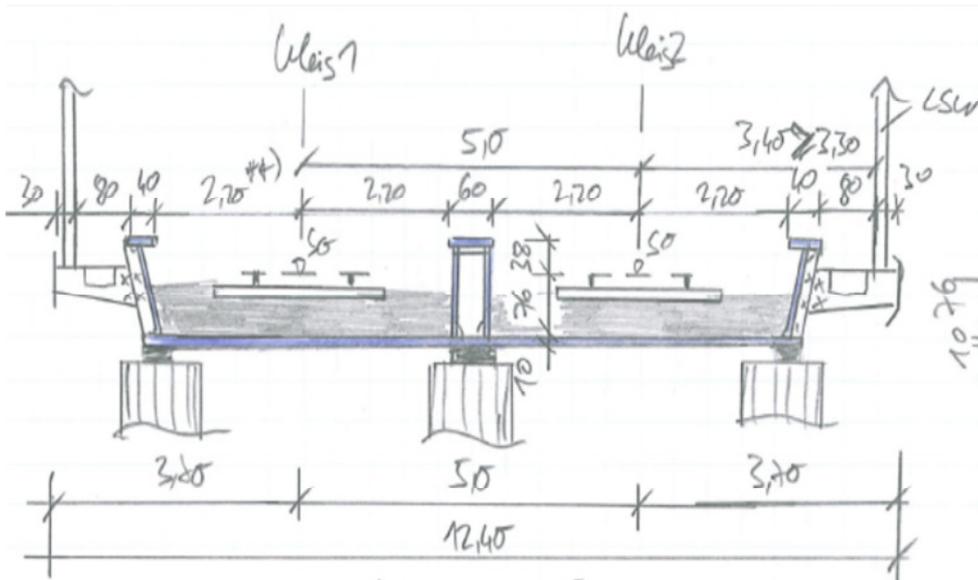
Alexanderstraße Variante 1c - einteiliger Stahltrögüberbau mit Regelbreite des Gleisbettes (Skizze)
